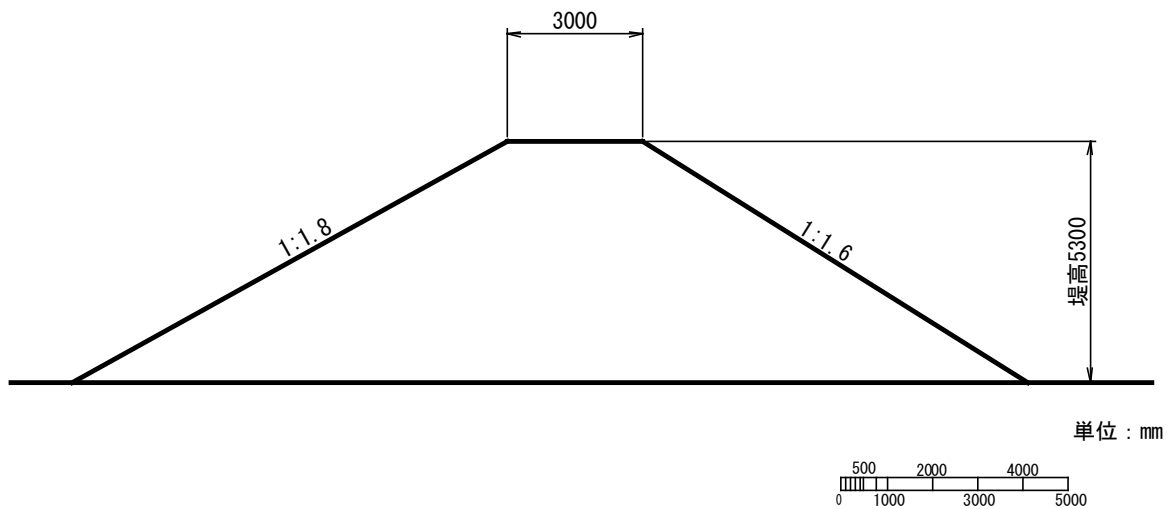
施工コスト算定用現況堤体断面-1 (H=5.3 m)
